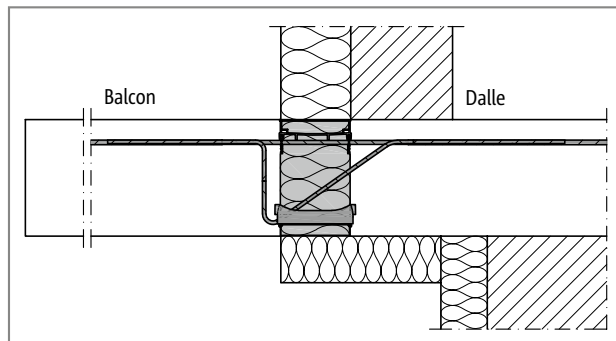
Schöck Isokorb® T Type K : Raccordement pour plancher indirect et ETICS
